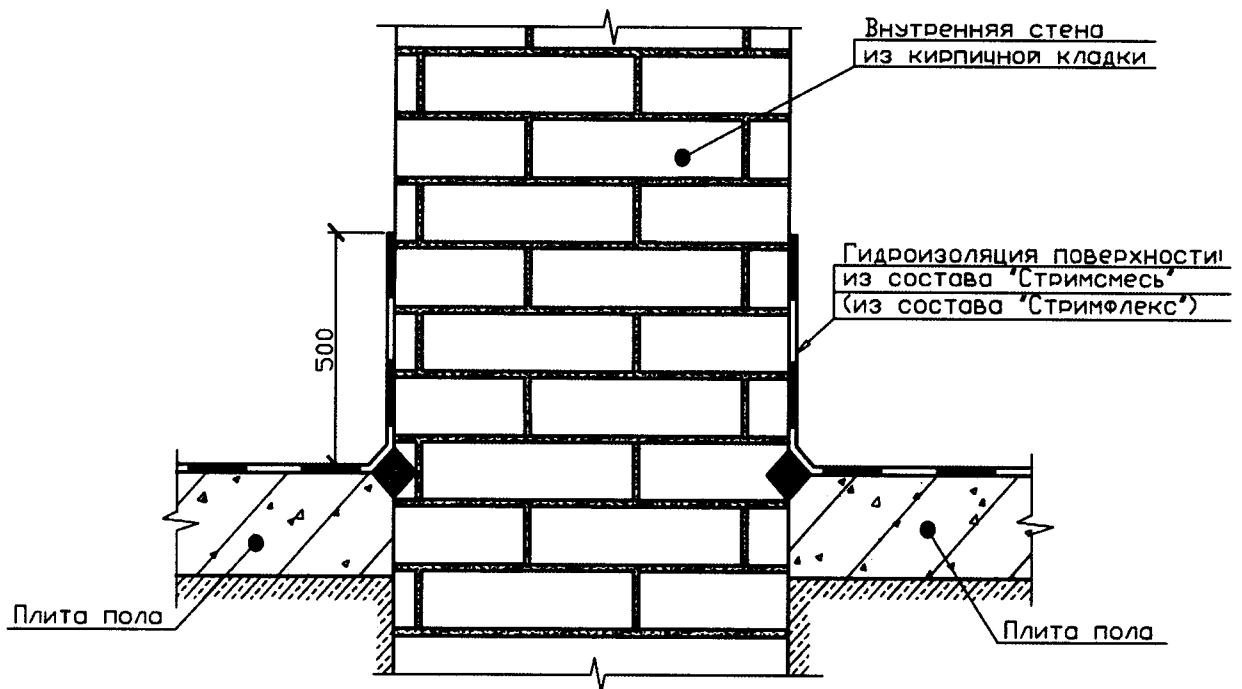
Гидроизоляция поверхностей конструкций из кирпичной кладки.
